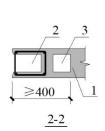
盲孔预制墙构造边缘构件构造示意
